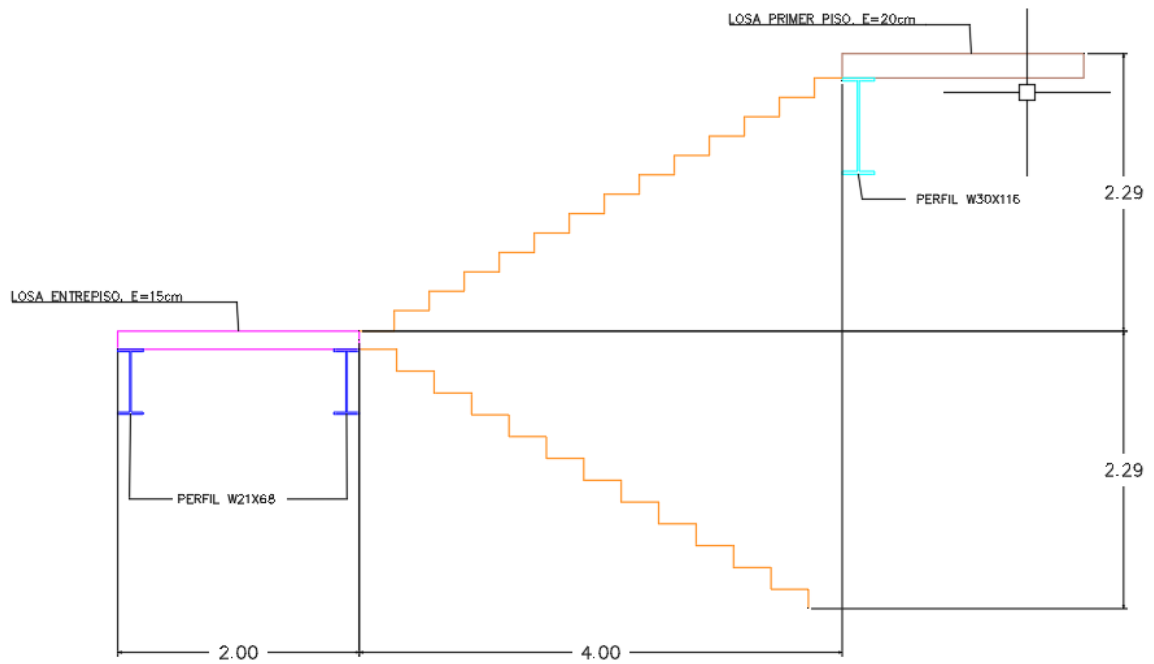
Vista lateral de las escaleras del primer piso de la edificación.
